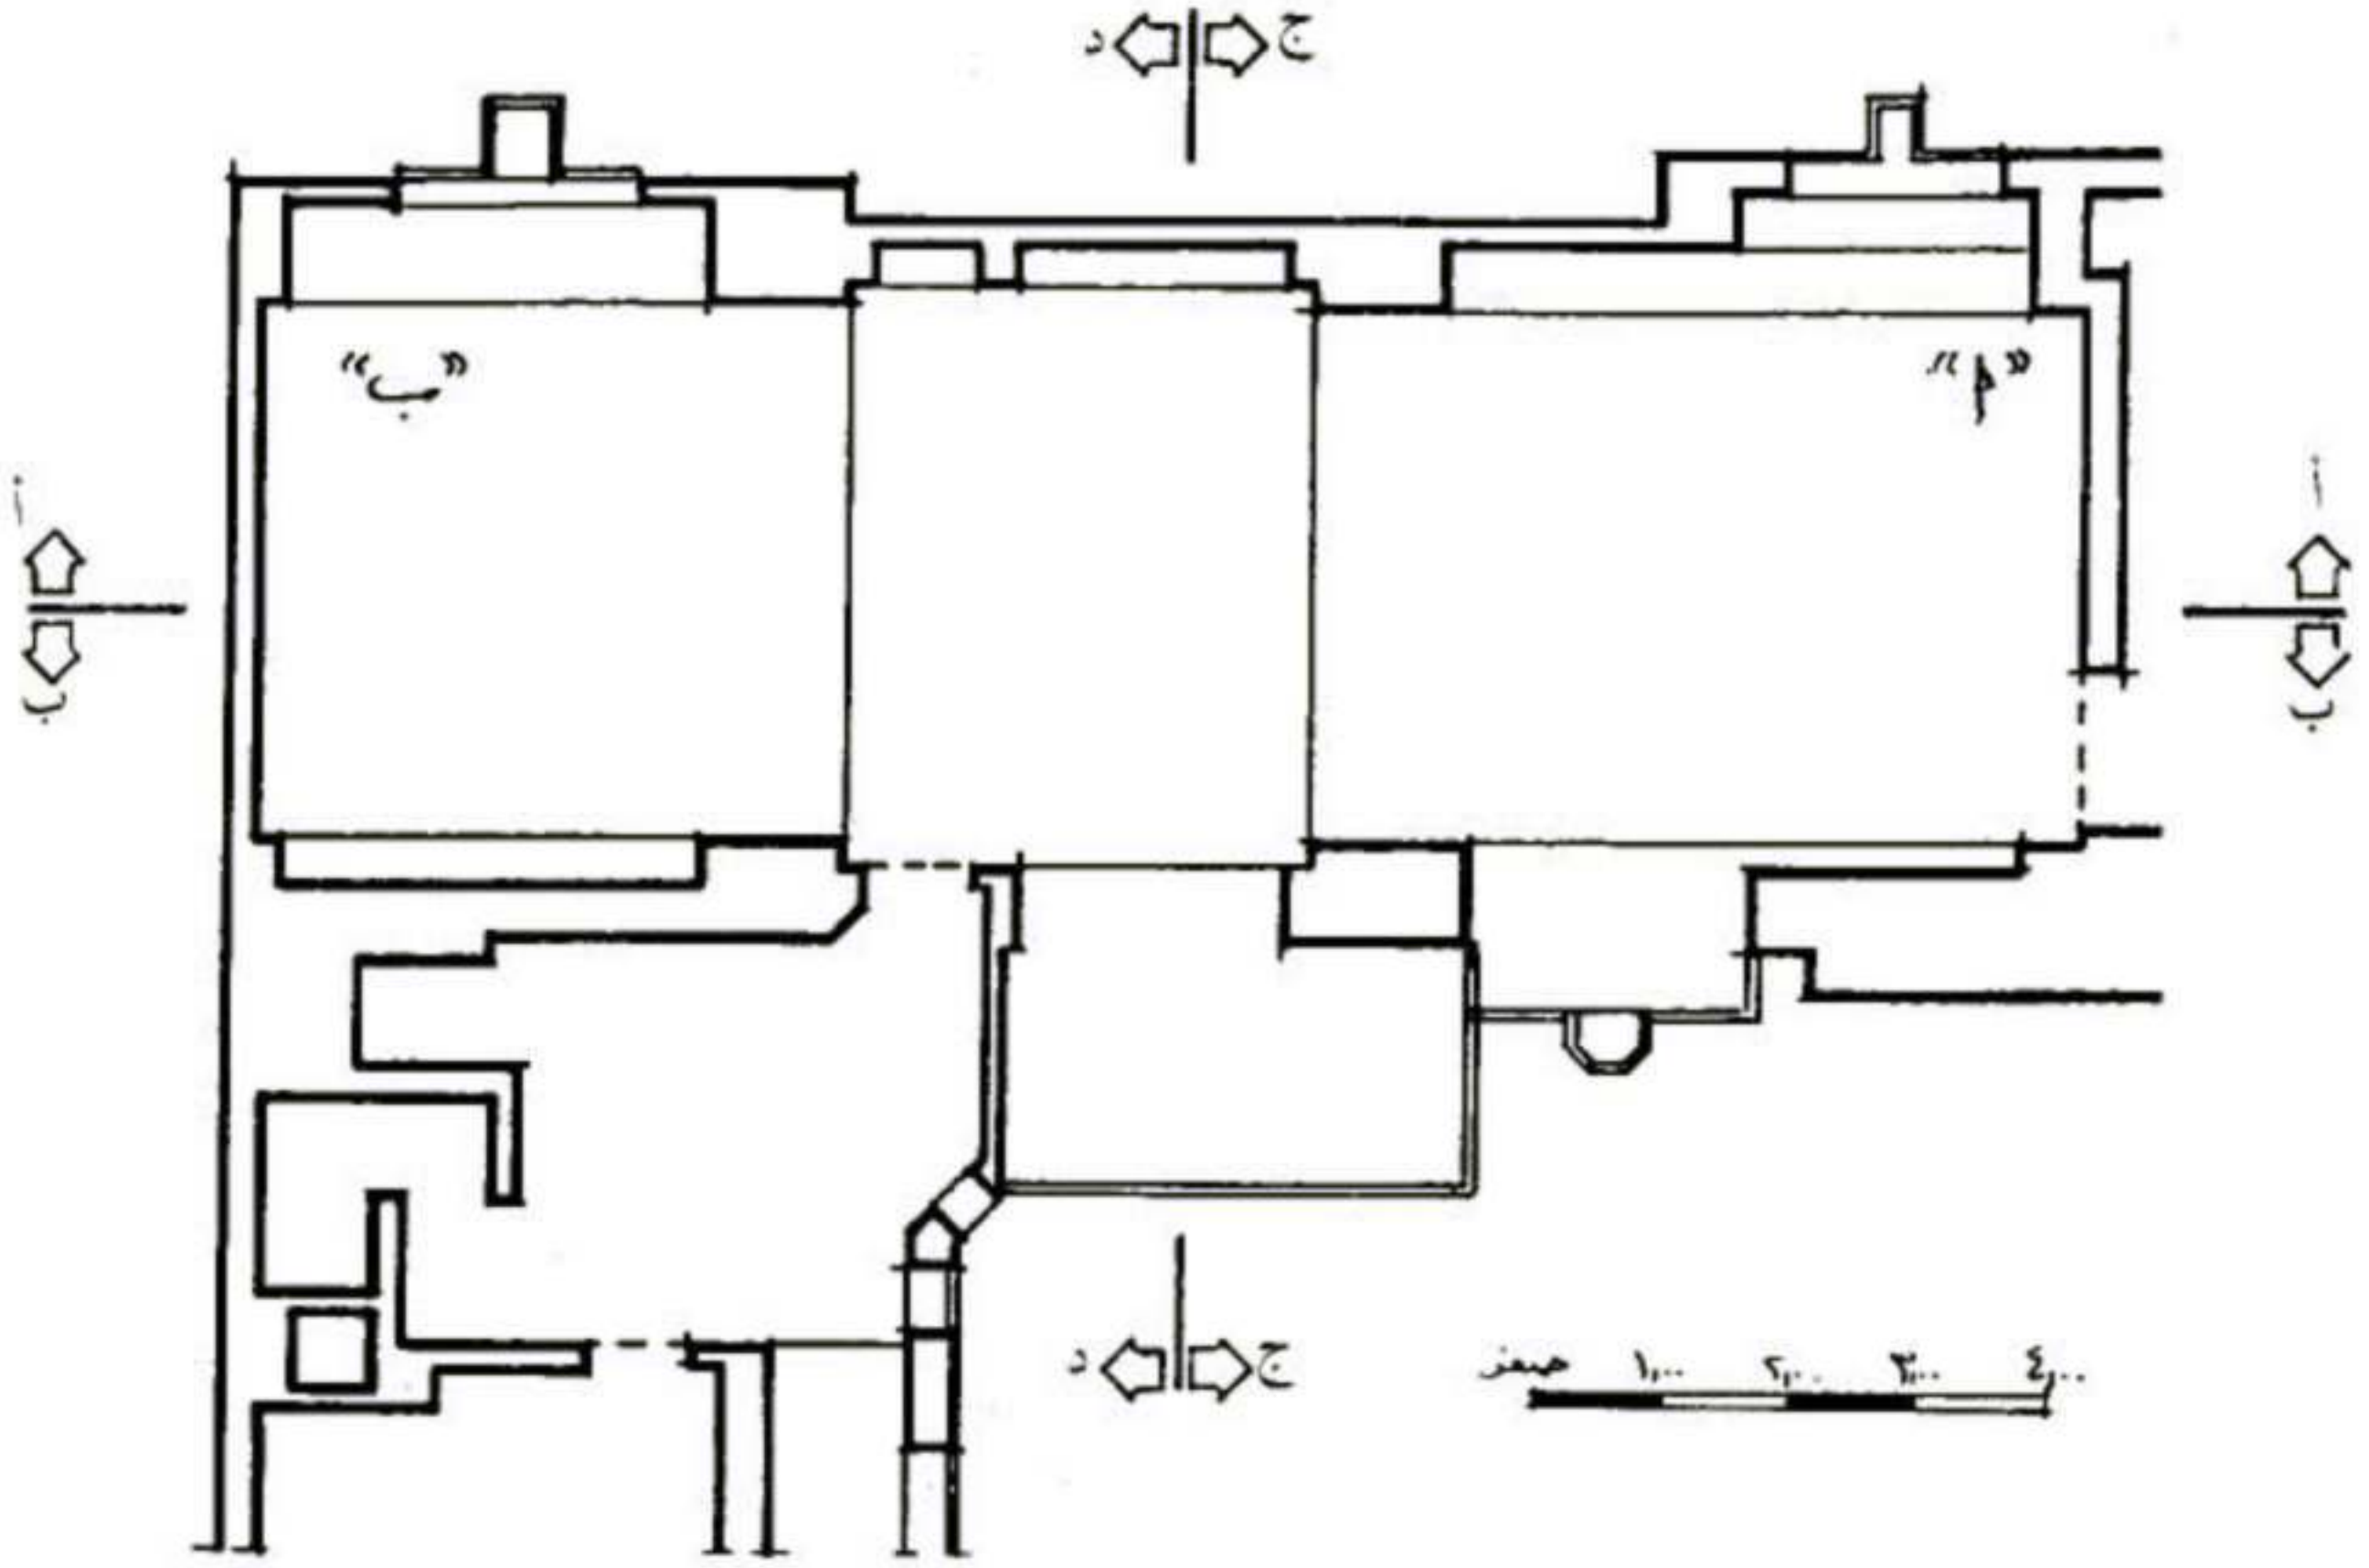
مسقط أفقى للدور الأرضى
